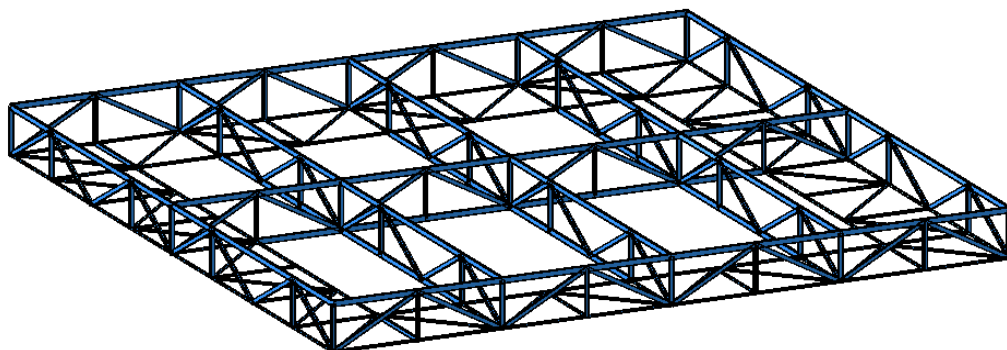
Просторова схема покриття будівлі із застосуванням перехресних легких ферм
